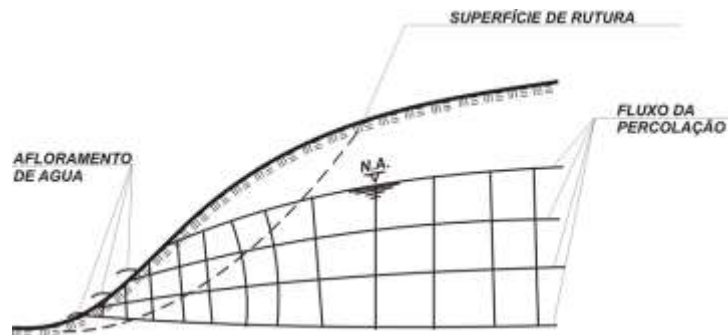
Projeto tipo 26 – Rebaixamento do lençol freático por aplicação de drenos sub-horizontais.
